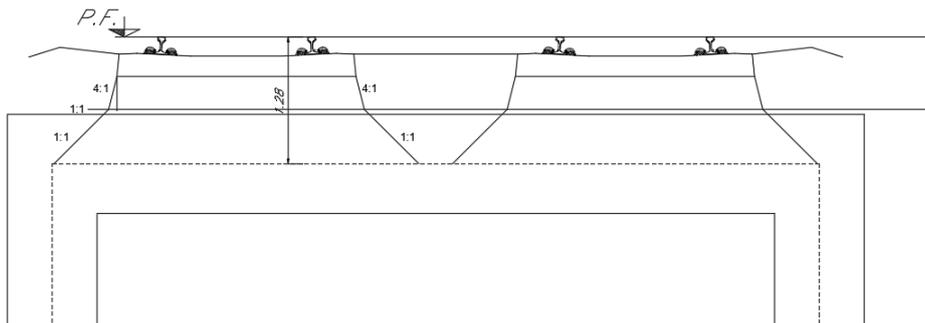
Distanza tra piano ferro e interasse soletta superiore
